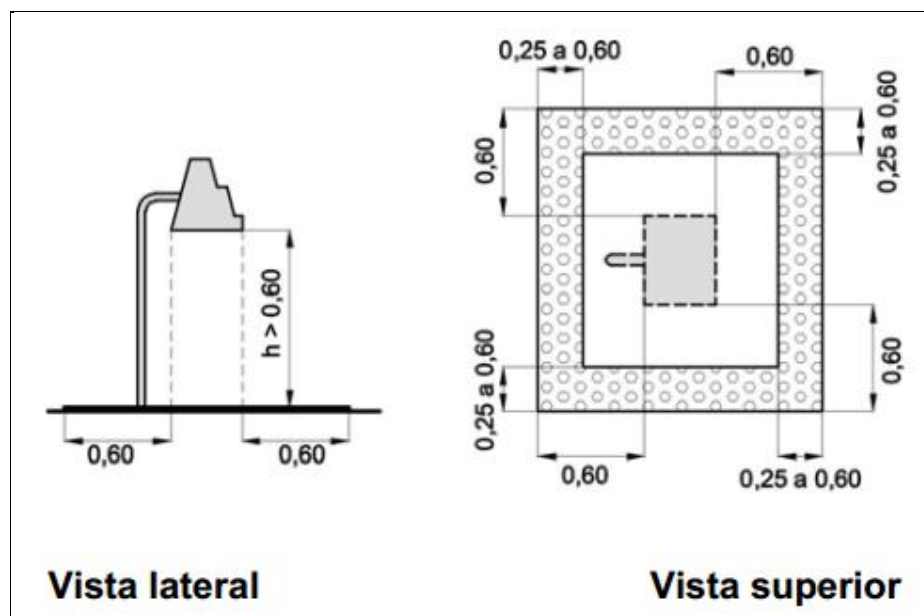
Sinalização tátil de alerta em obstáculos suspensos
